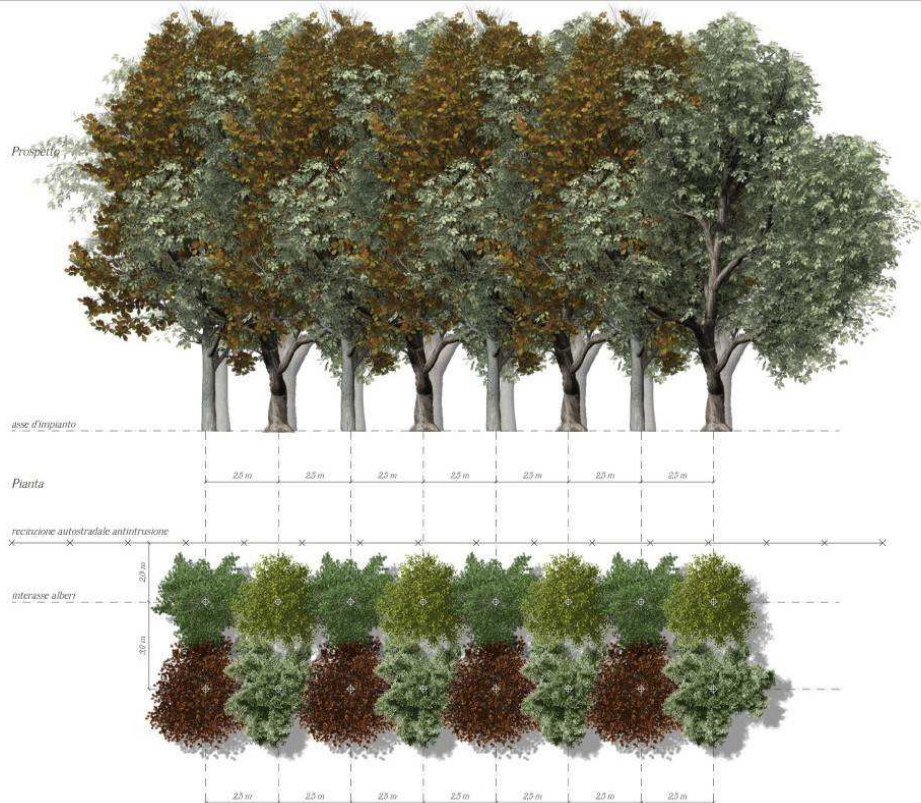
TIPOLOGIA C – PROSPETTO E PIANTA
